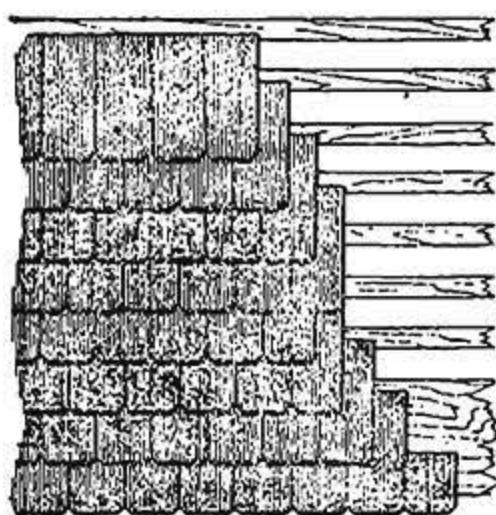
Покрытие кровли асбестшифером по французскому способу (укладка половинных шаблонов).
